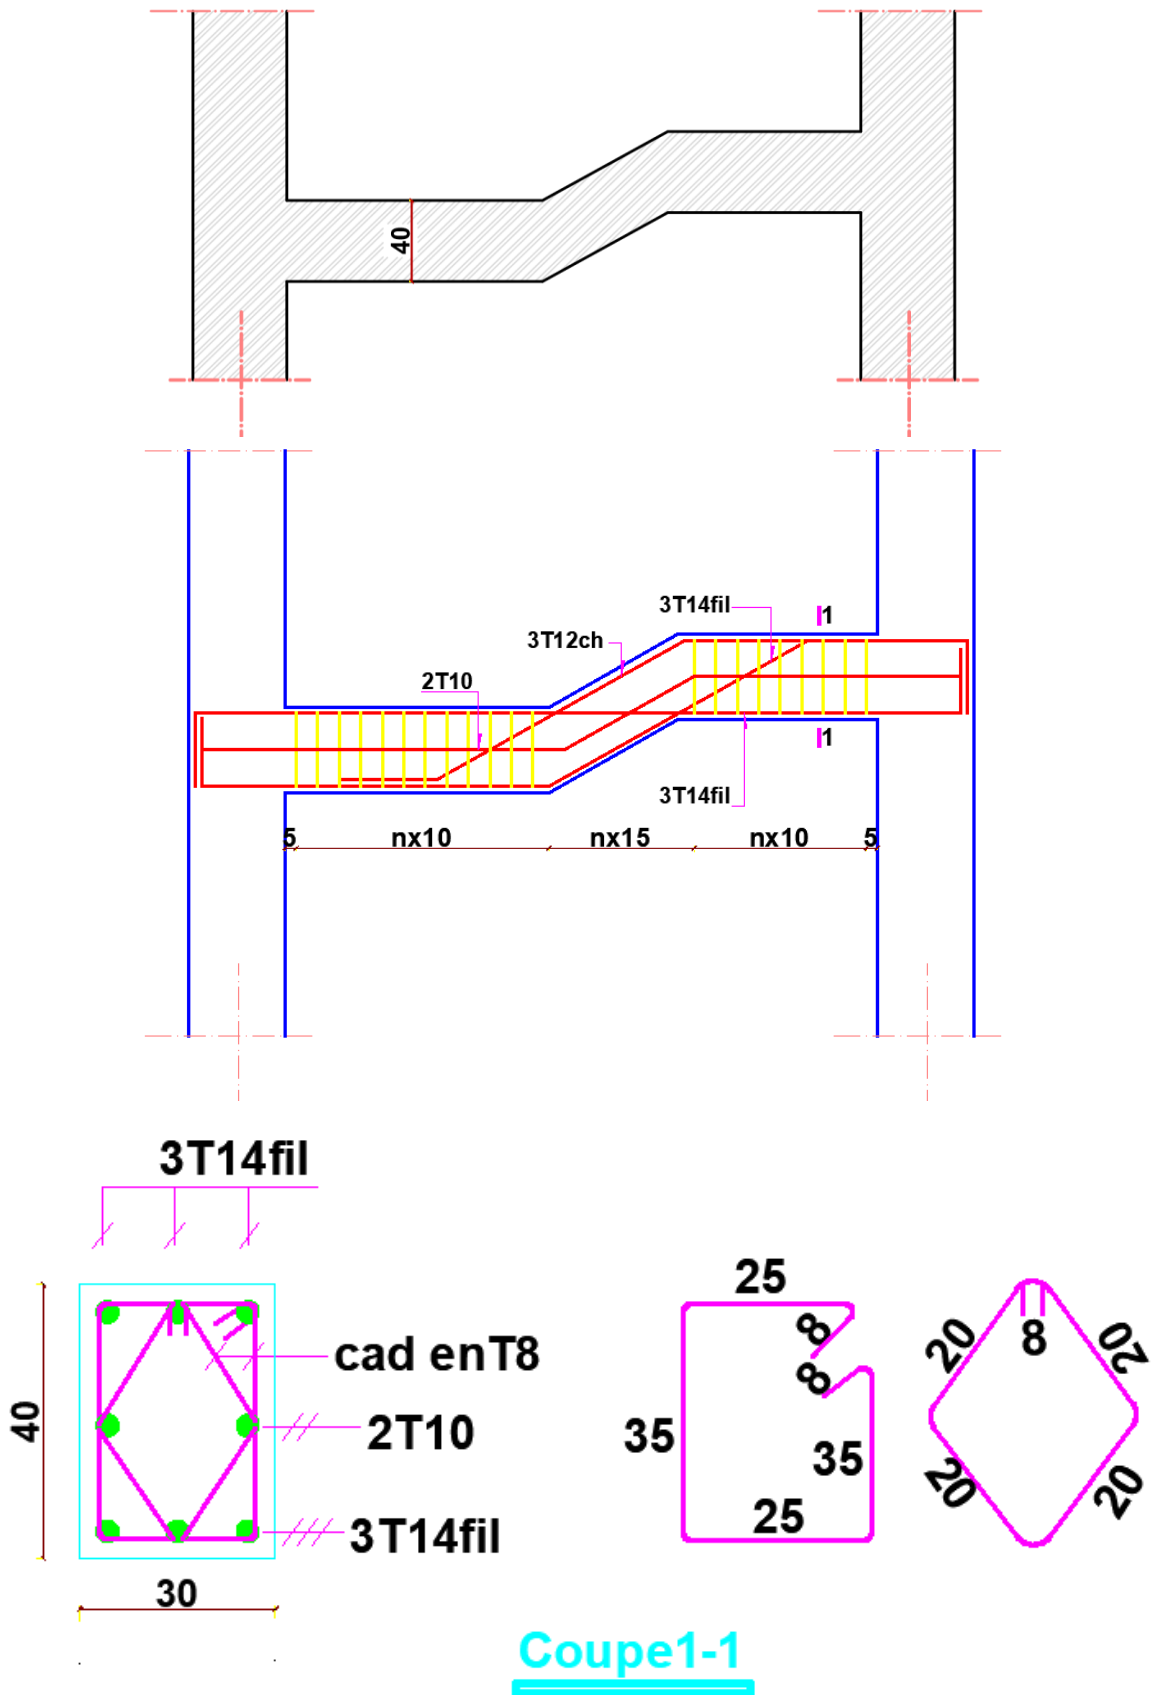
Schéma de coffrage et ferrailage du poutre brisée
